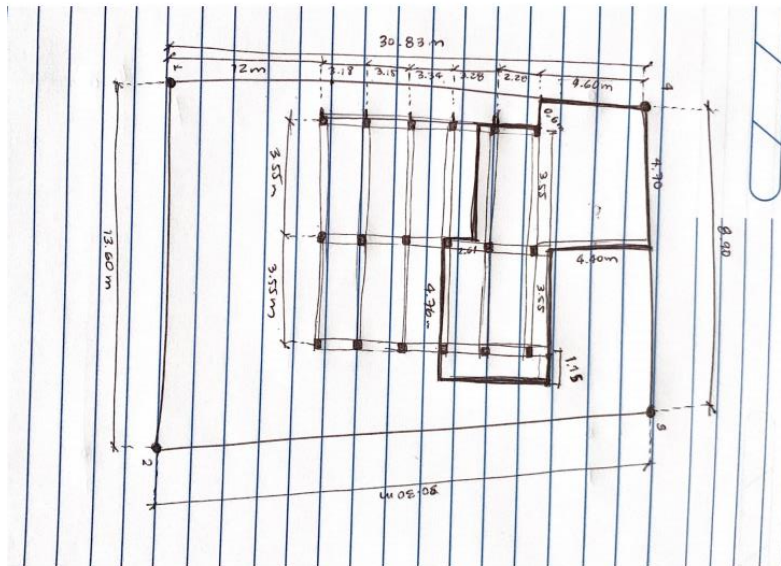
Levantamiento a mano de construcción de 339.69 m²
